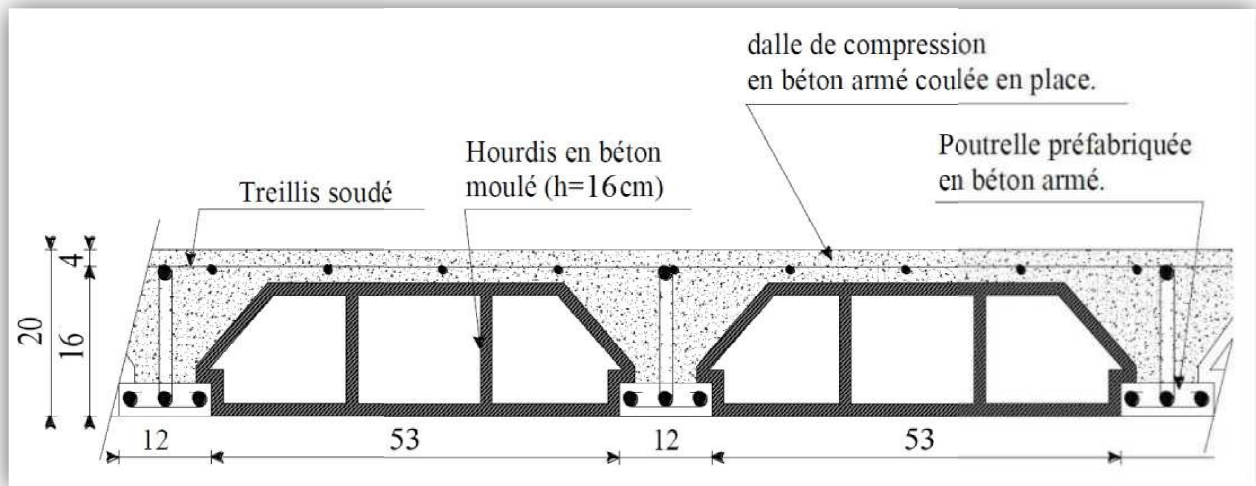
Coupe transversale d'un plancher en corps creux.
